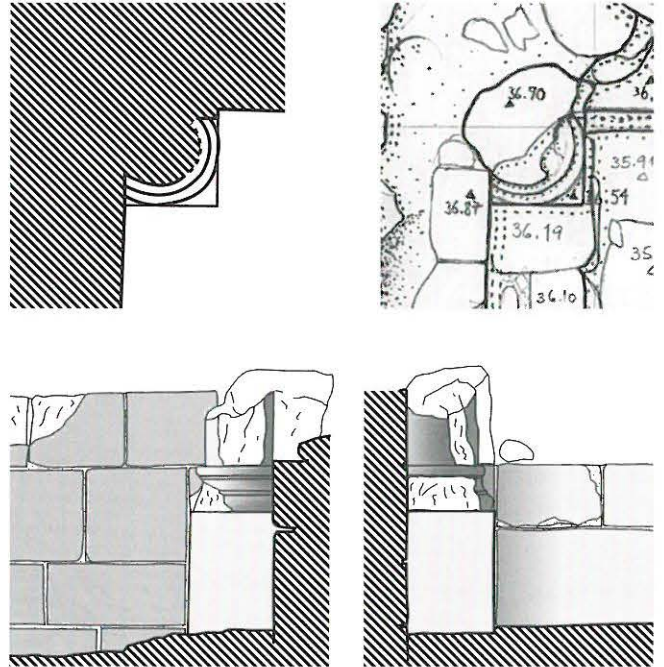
Grundriss und Ansichten der Viertelssäule in der Nordwestecke des Nordquerhauses. M 1:20.
